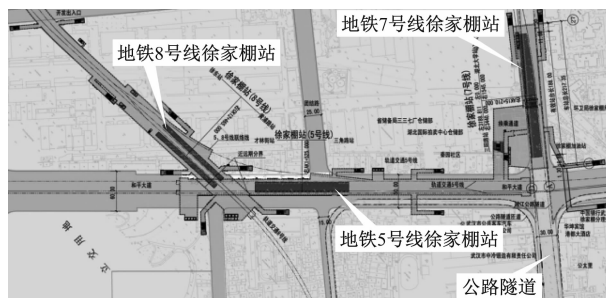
地铁 5、7、8 号线 3 线换乘总平面图
